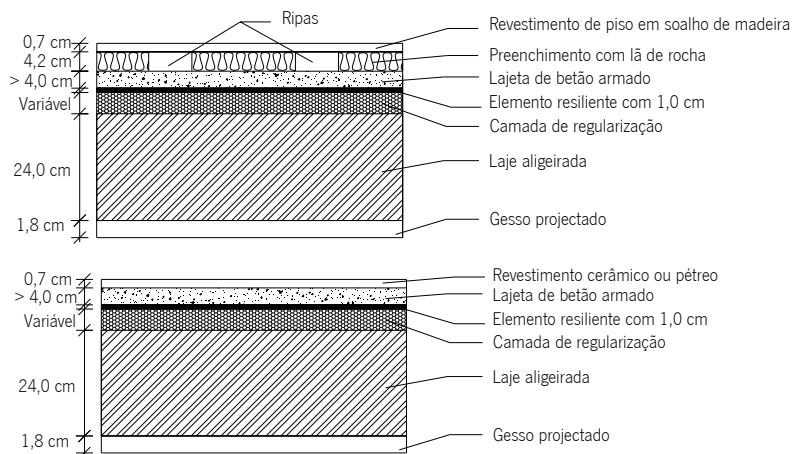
Pavimento de separação entre duas habitações com soalho de madeira e com material cerâmico ou pético – Pav13.1 e Pav13.2
